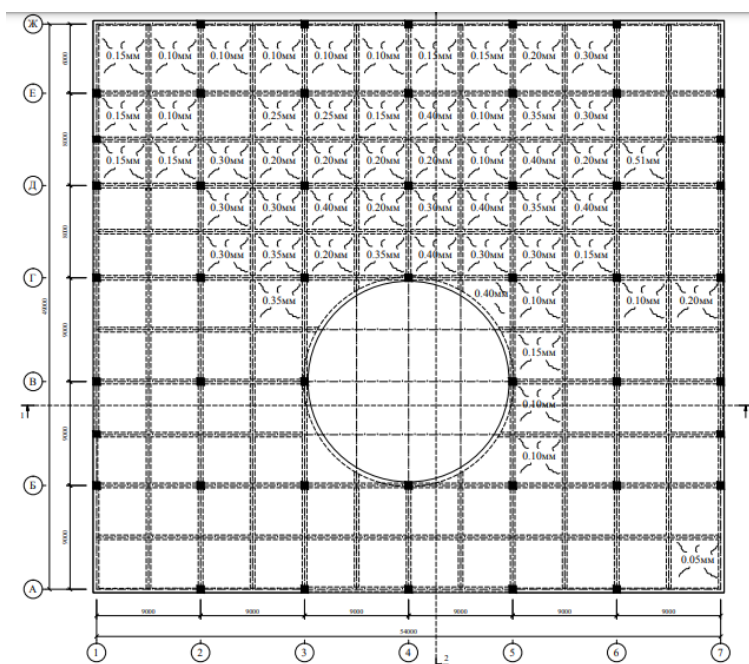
Схема раскрытия трещин в плитах перекрытия нижнего уровня на отметке 0,000 (Павильон 1, блок 1) (материал авторов).
